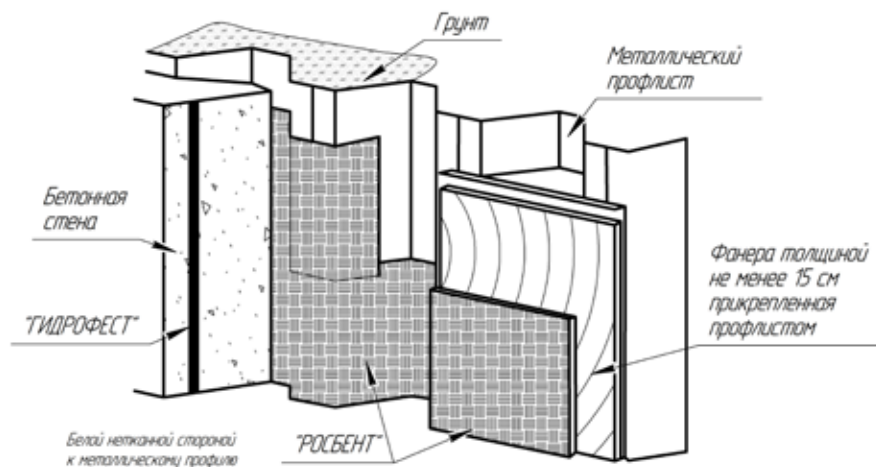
Вариант укладки «Росбент» на стену из металлического профлиста
